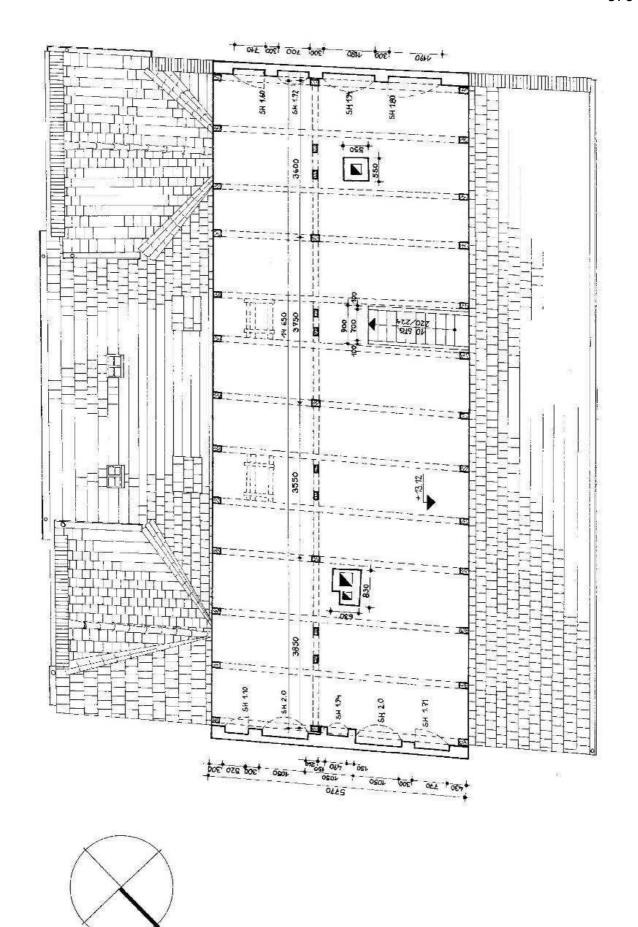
Webergasse 1, Grundriss Spitzboden Vermessung
